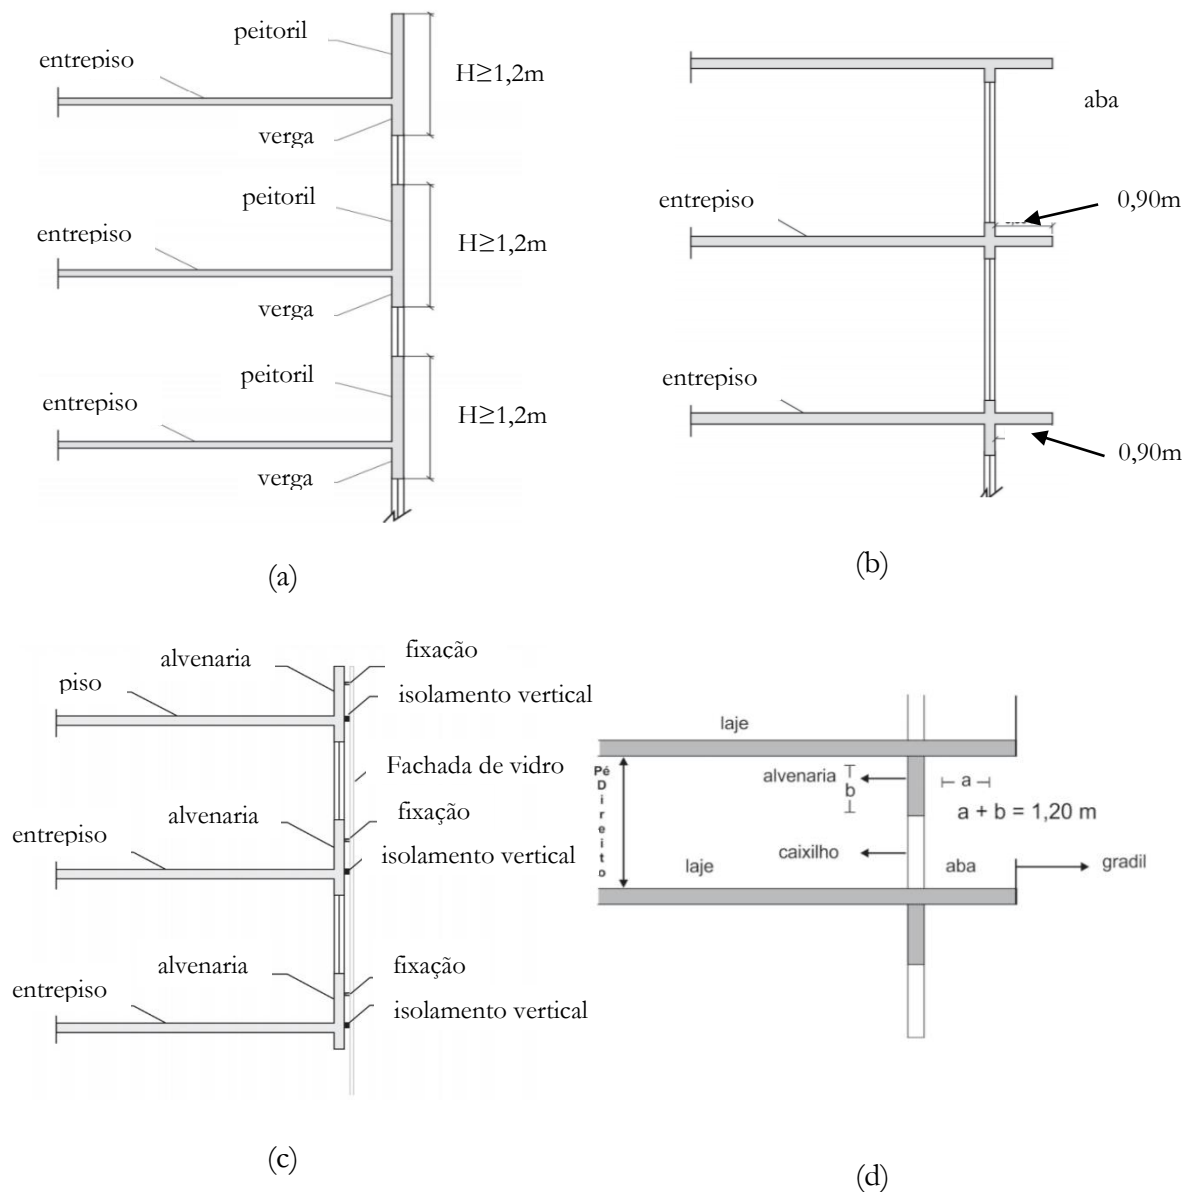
Modelos de compartimentação vertical: espaçamento vertical entre aberturas (a); avanço de laje técnica (b); fachada com pele de vidro (c) e conjunto de avanço de laje técnica e verga-peitoril (d).
